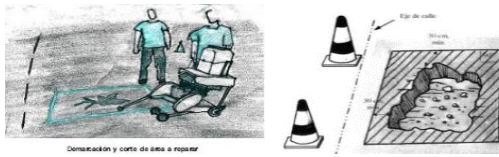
Bacheo profundo, Dosificación y corte de área a recuperar- - Fuente (Deterioros en pavimentos flexibles y rígidos)- Ricardo Javier Miranda Rebolledo Valdivia – Chile – 2010
